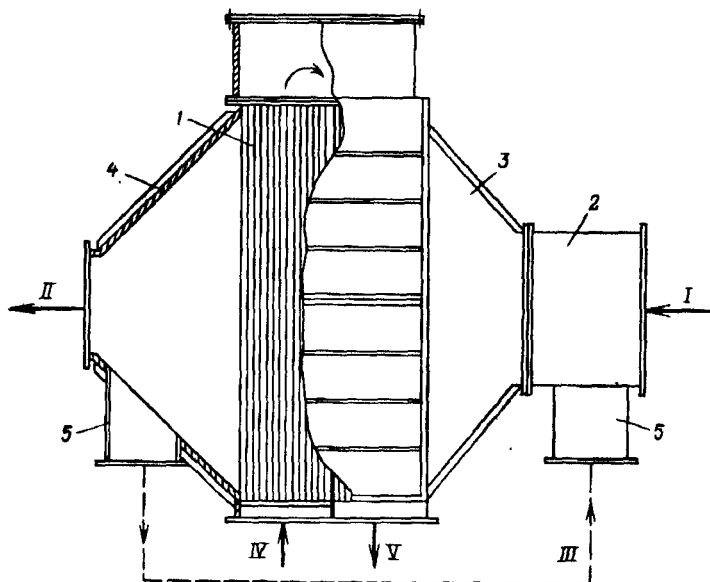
Устройство воздухоподогревателя типа ВТР:
